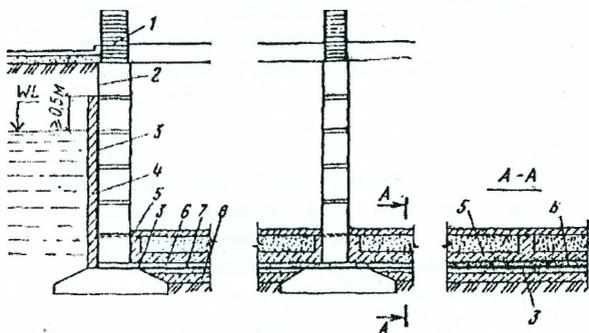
Гидроизоляция подвала при напоре подземных вод до 0,5 м
